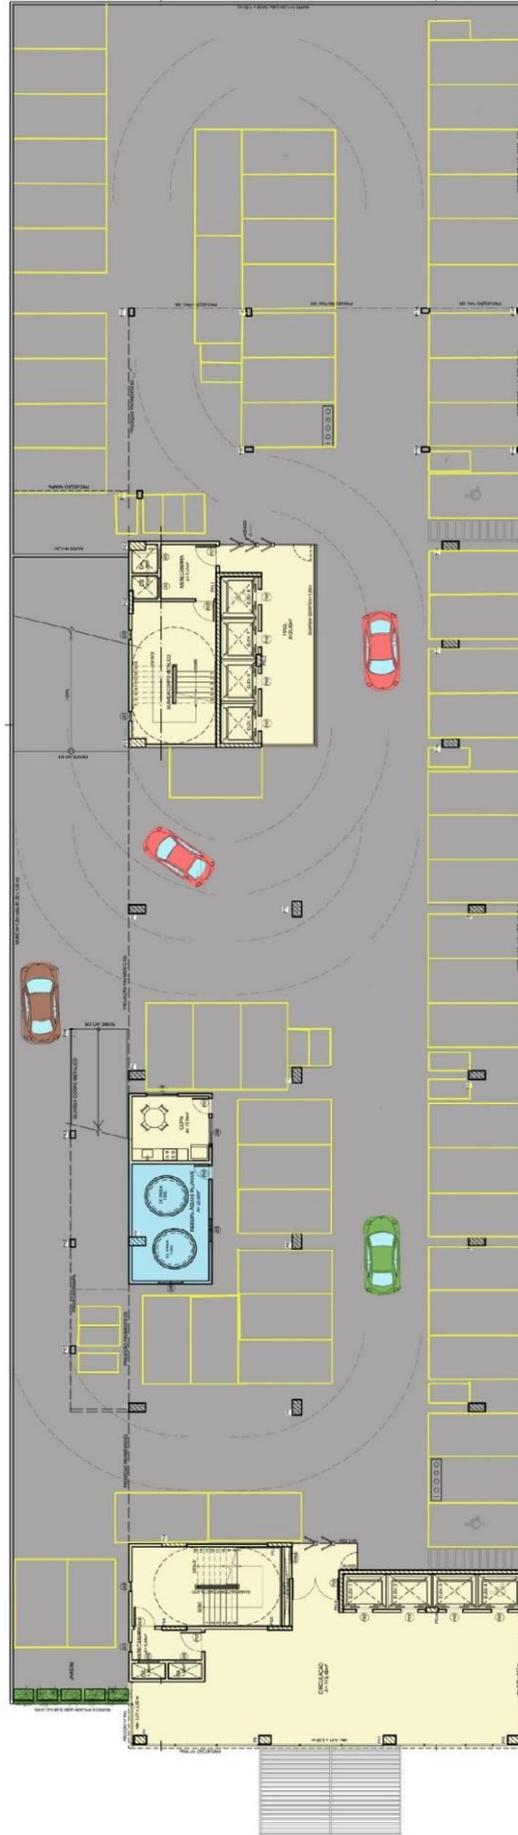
Representação em planta baixa do Pavimento G3 (garagem).
